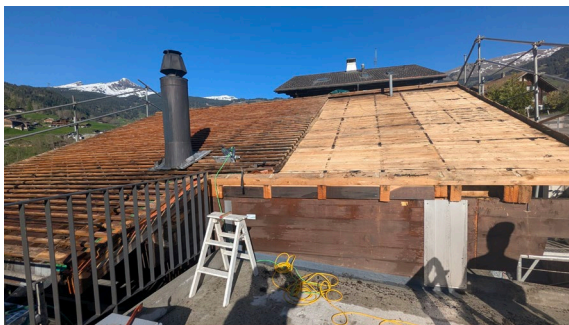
Rückbau der Dachlattung (Foto M. Arnold, OLWO)
